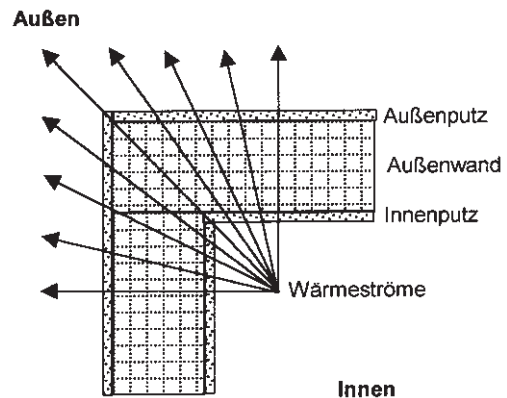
Schematische Darstellung der Wärmeströme in einem Eckbereich (Grundrisskizze)
